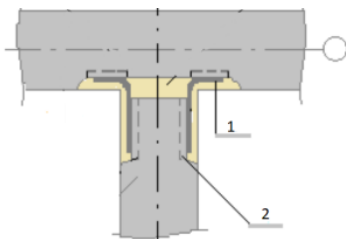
1 – уголок, гнутый из металлической пластины; 2 – закладные детали панели
